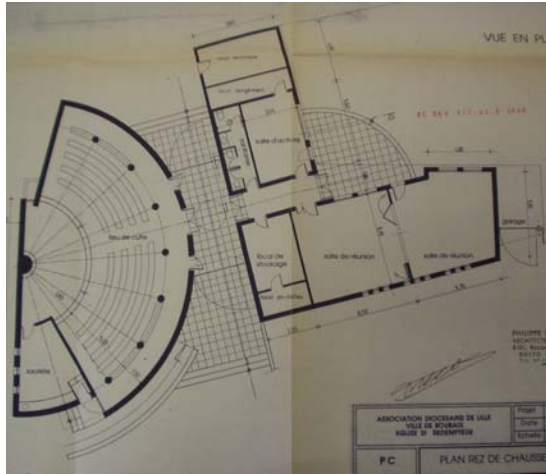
Plan, 26-10-92 (AM Roubaix186 W 10.26824)
